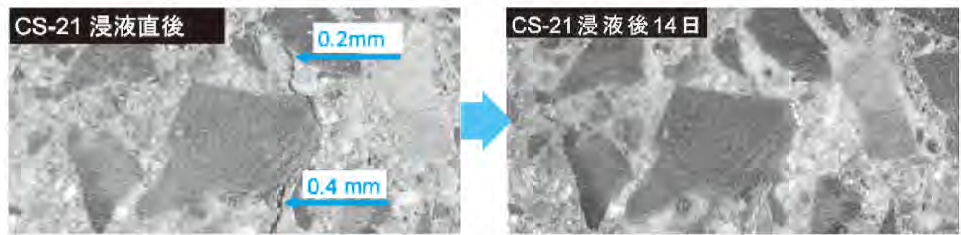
けい酸塩系のひび割れ充填効果の例(アストン技術資料より抜粋)
